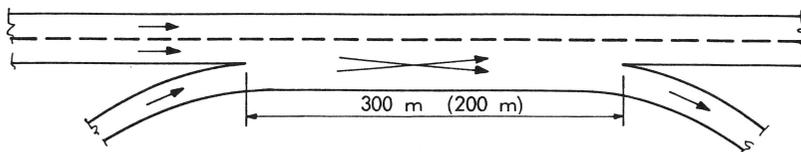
Avstand mellom tilknytninger og forgreninger på ramper
